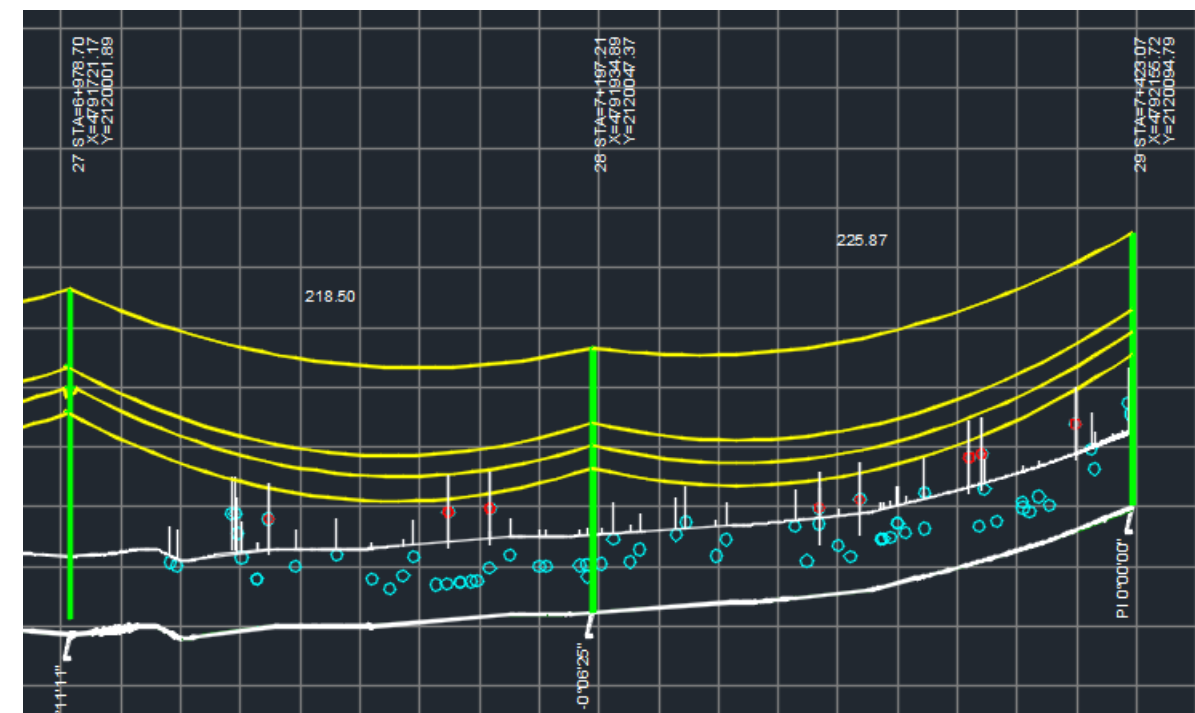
Vista en Planta individuos para Tala o aprovechamiento estructuras 27 a 29
